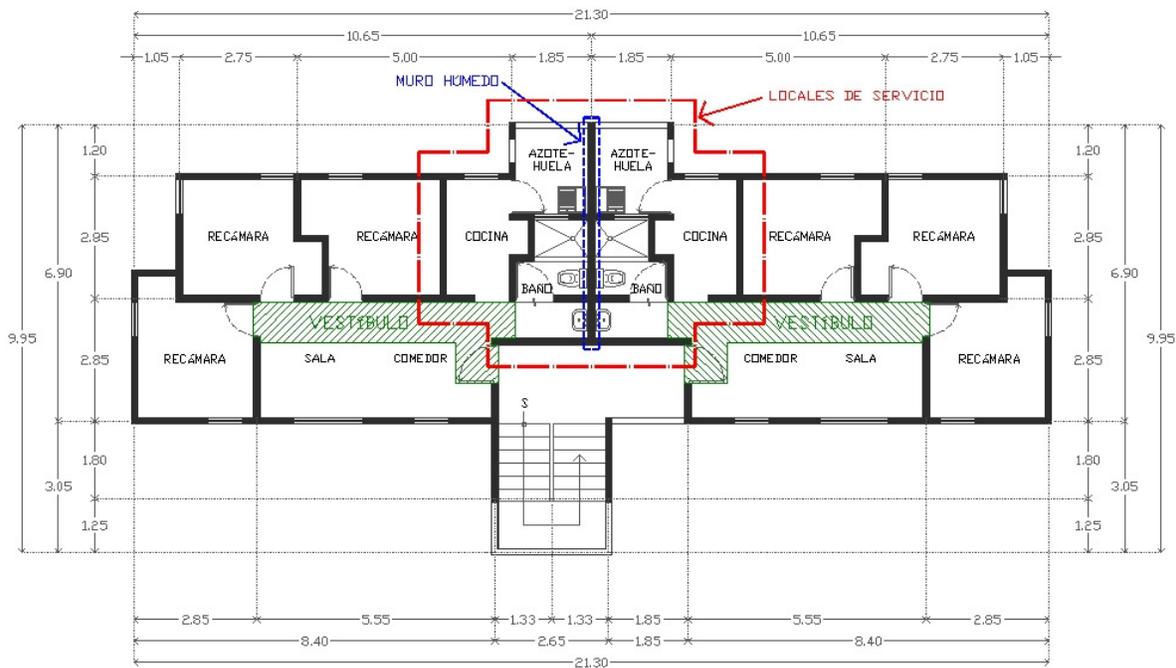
Planta tipo de edificio multifamiliar de cinco niveles. Unidad habitacional Héroes de Guerrero. Chilpancingo, Gro. Fuente: elaboración propia.
